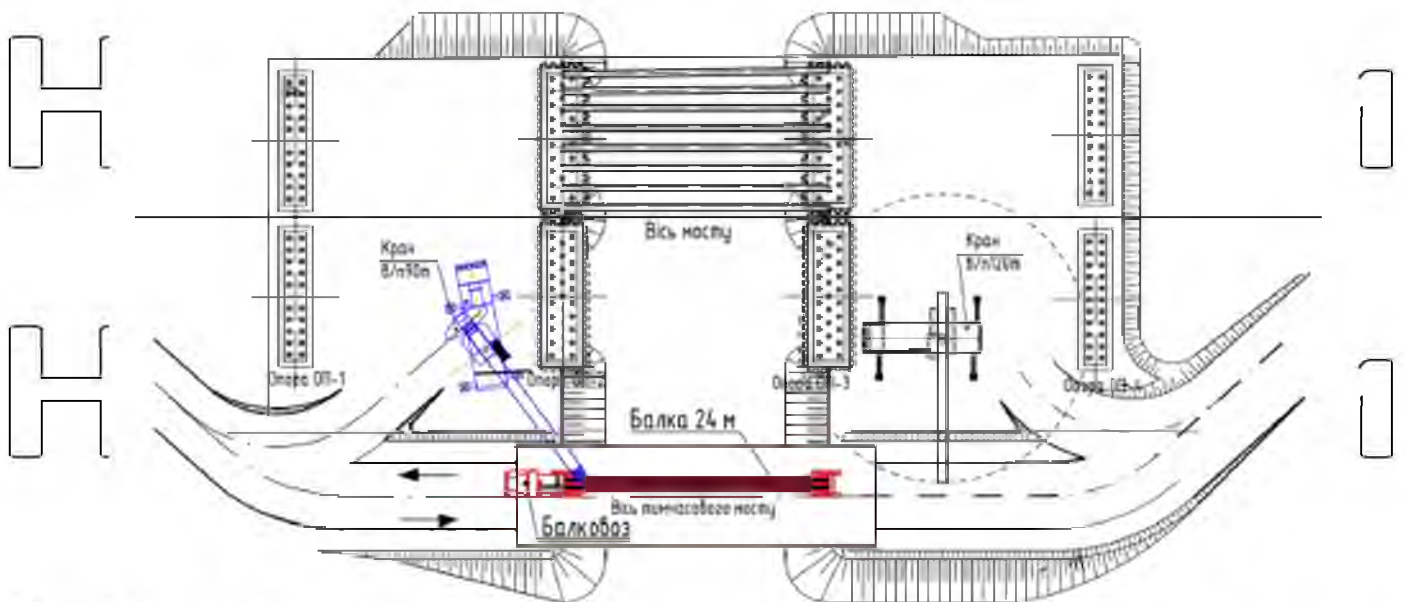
Сплан монтажу розрізних залізобетонних балок прогонової будови дощипною
